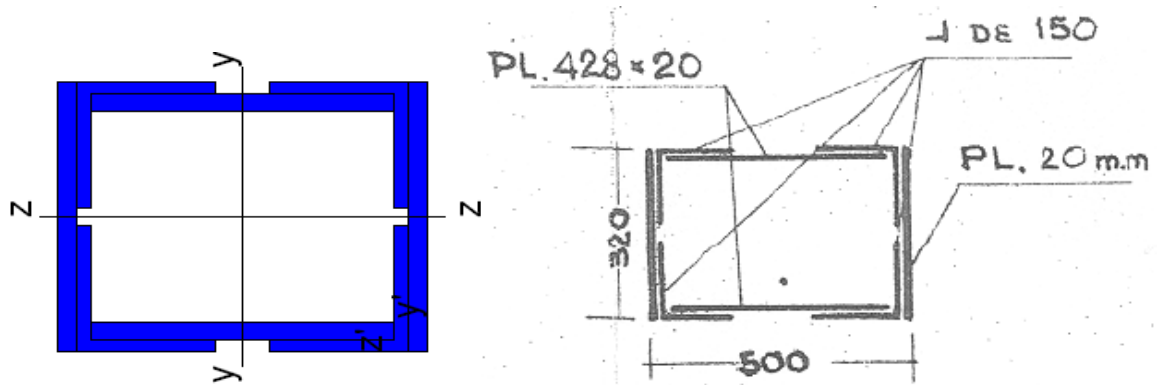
Pilar planta baixa, 1a i 2a. [1]
